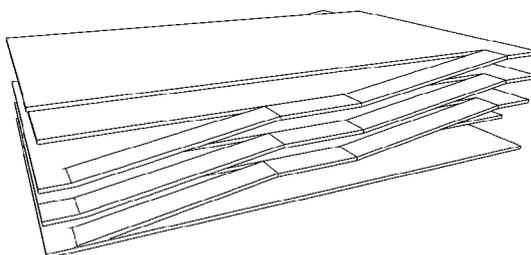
Rampas retas (adaptado de Klose, Drietrich – Parkhauser und Tiefgarage)
